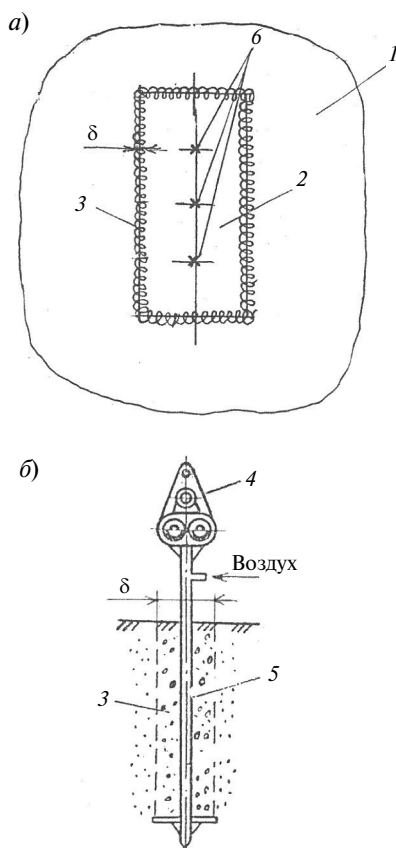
Пояснительные схемы к изоляции грунтового массива путем аэрирования грунта:
